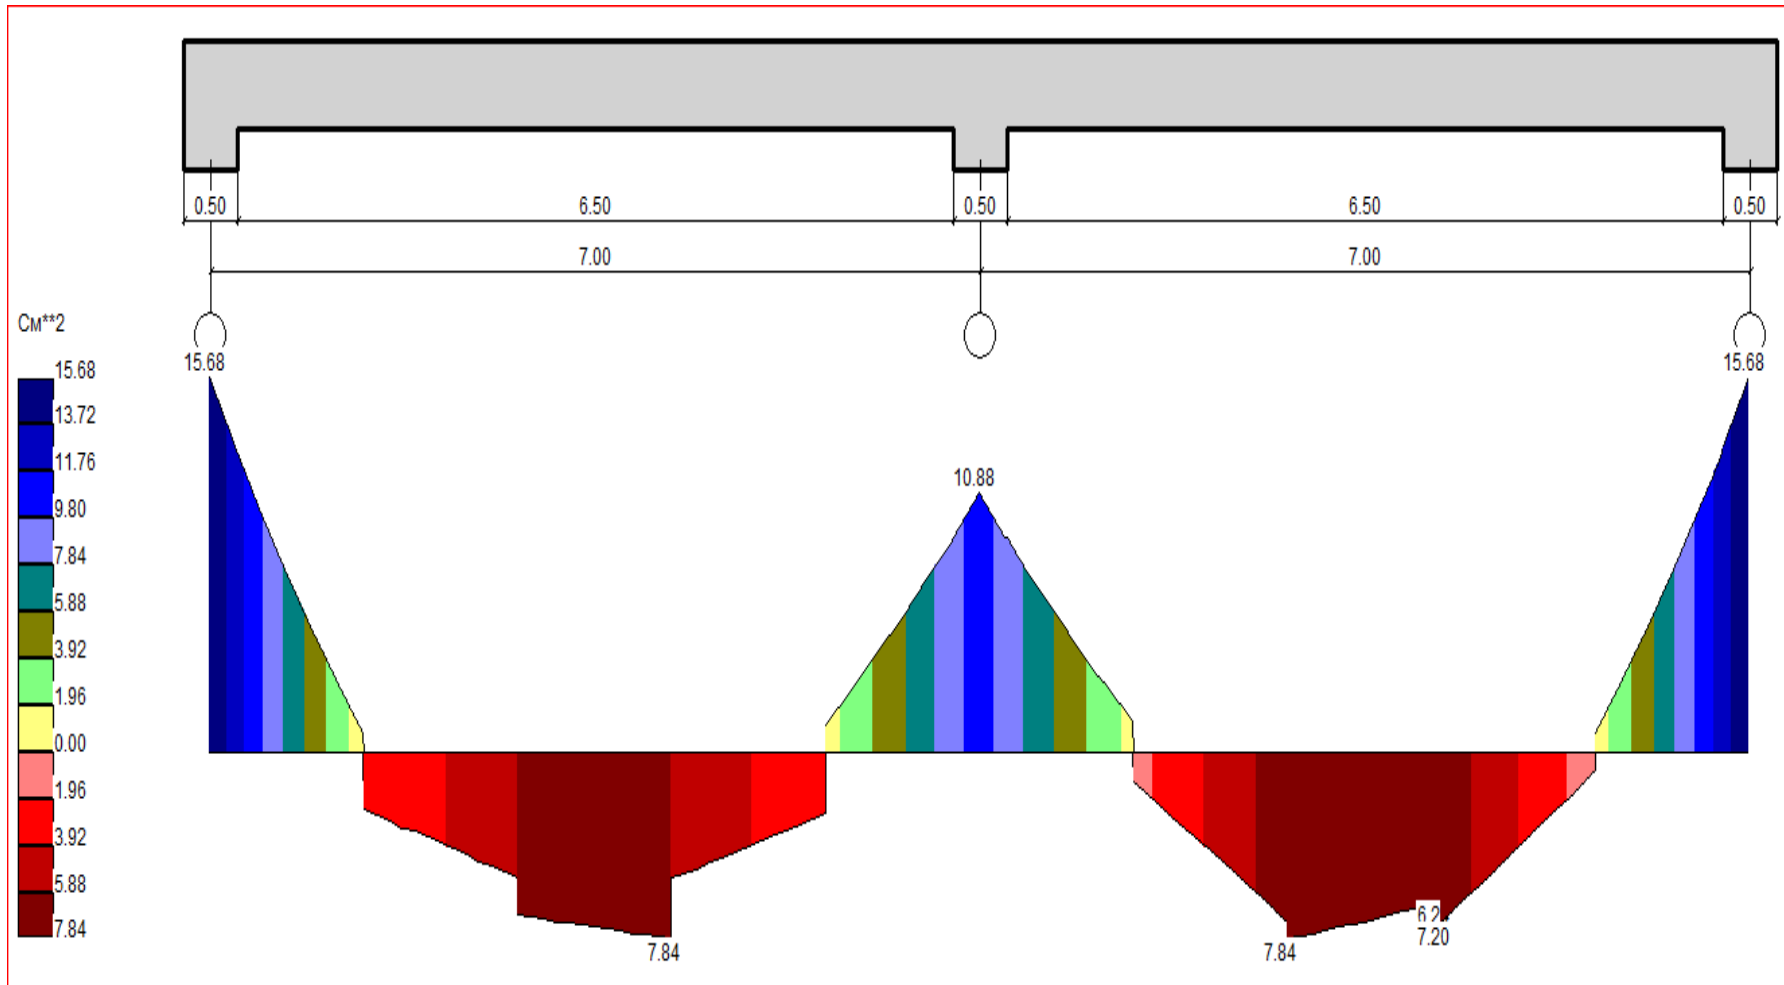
Варіант балково-плитного перекриття. Балка Б3-9. Епюра подовжнього теоретичного армування
